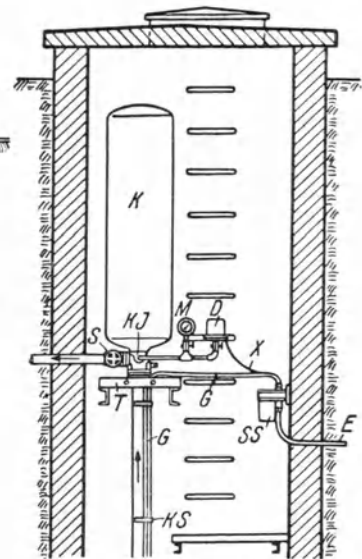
Aufbau einer Hauswasserversorgungsanlage mit Kleintauchpumpe und Druckkessel im Brunnen-schacht. (Pumpenfabrik E. Vogel in Stockerau, sterreich u. Znaim, CSR.)
